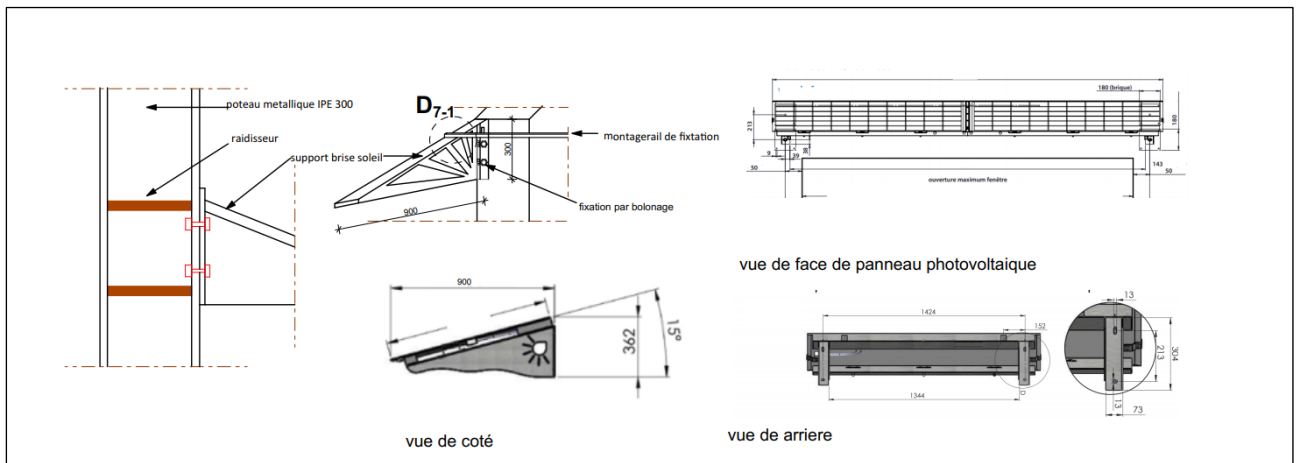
Le détail de fixation des panneaux photovoltaïques sur la façade.
